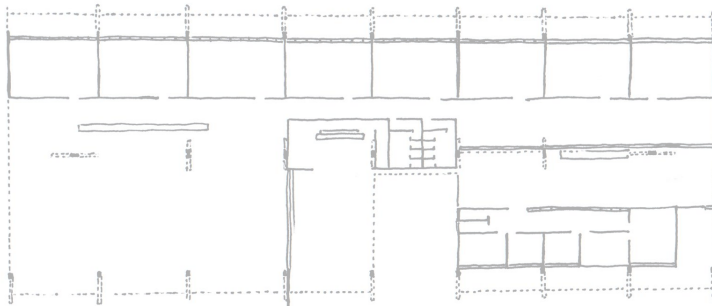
Desenho Esquemático da planta baixa da Escola de Itanhaém, SP.
